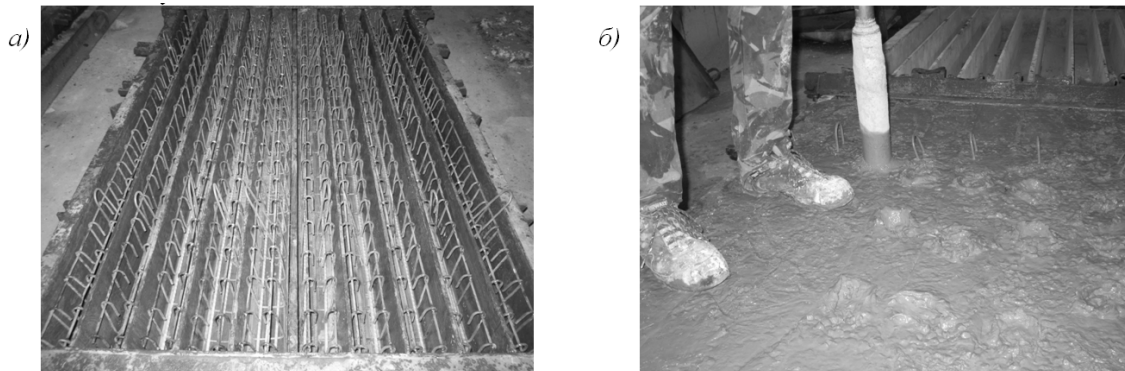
Армування і бетонування зразків: *а* - просторові арматурні каркаси в металевій опалубці перемичок ЗПБ 21-8; *б* – ущільнення бетонної суміші глибинним вібратором
